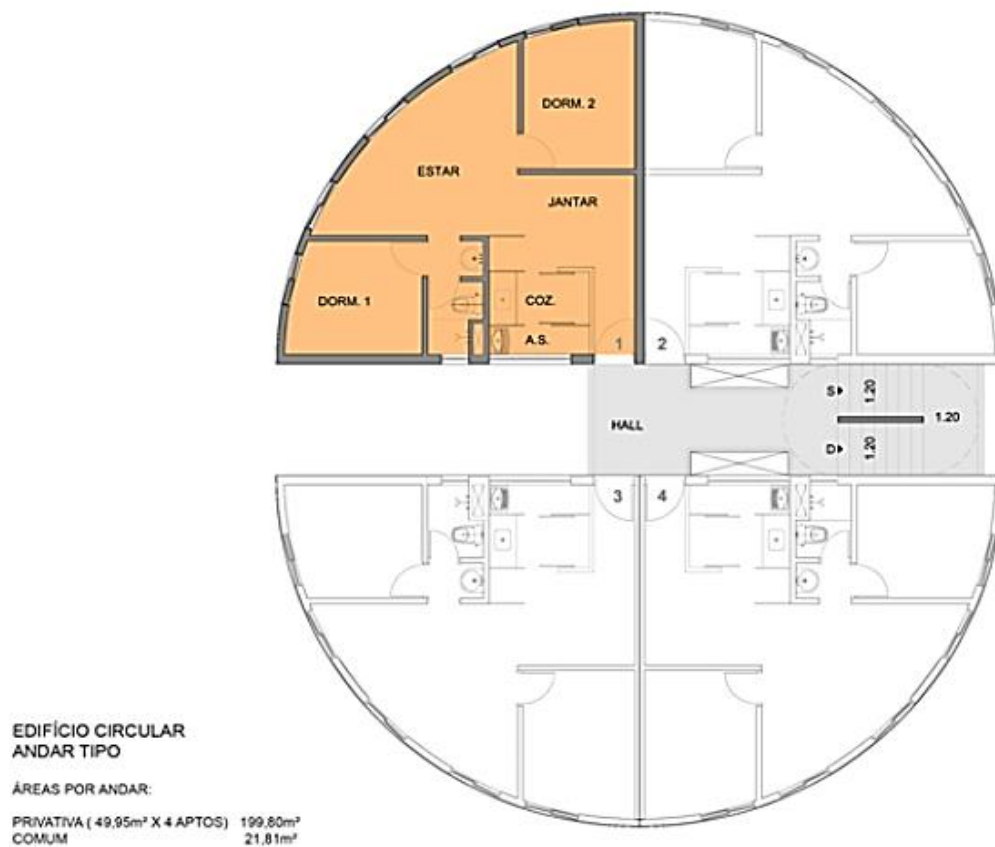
Planta do Conjunto Habitacional de Heliópolis - Fonte: Aaj Press.
